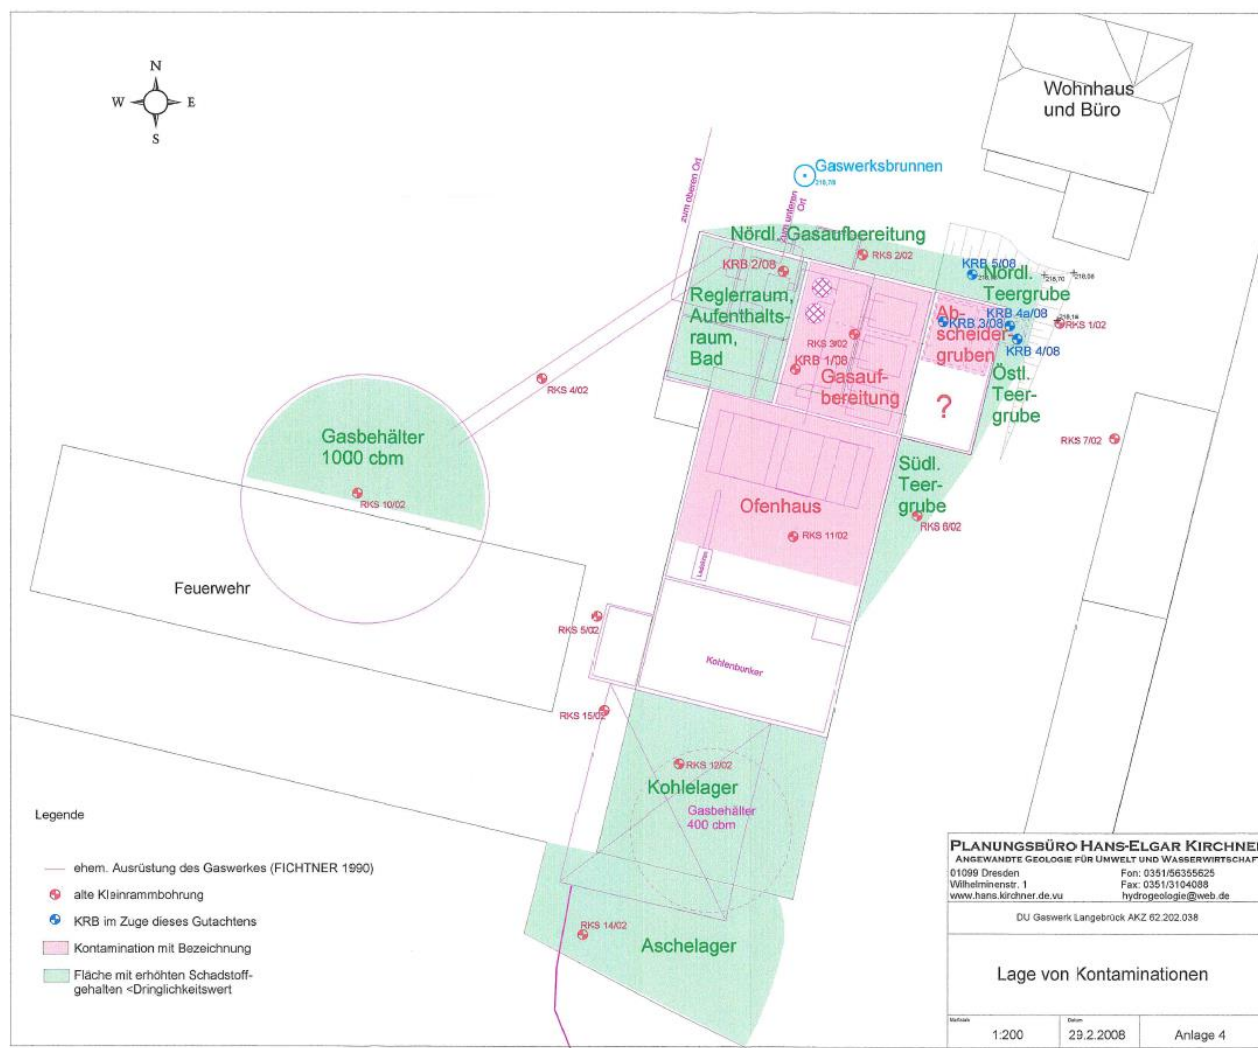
Lageplan mit noch vorhandenen Objekten (aus Anlage /8/).
